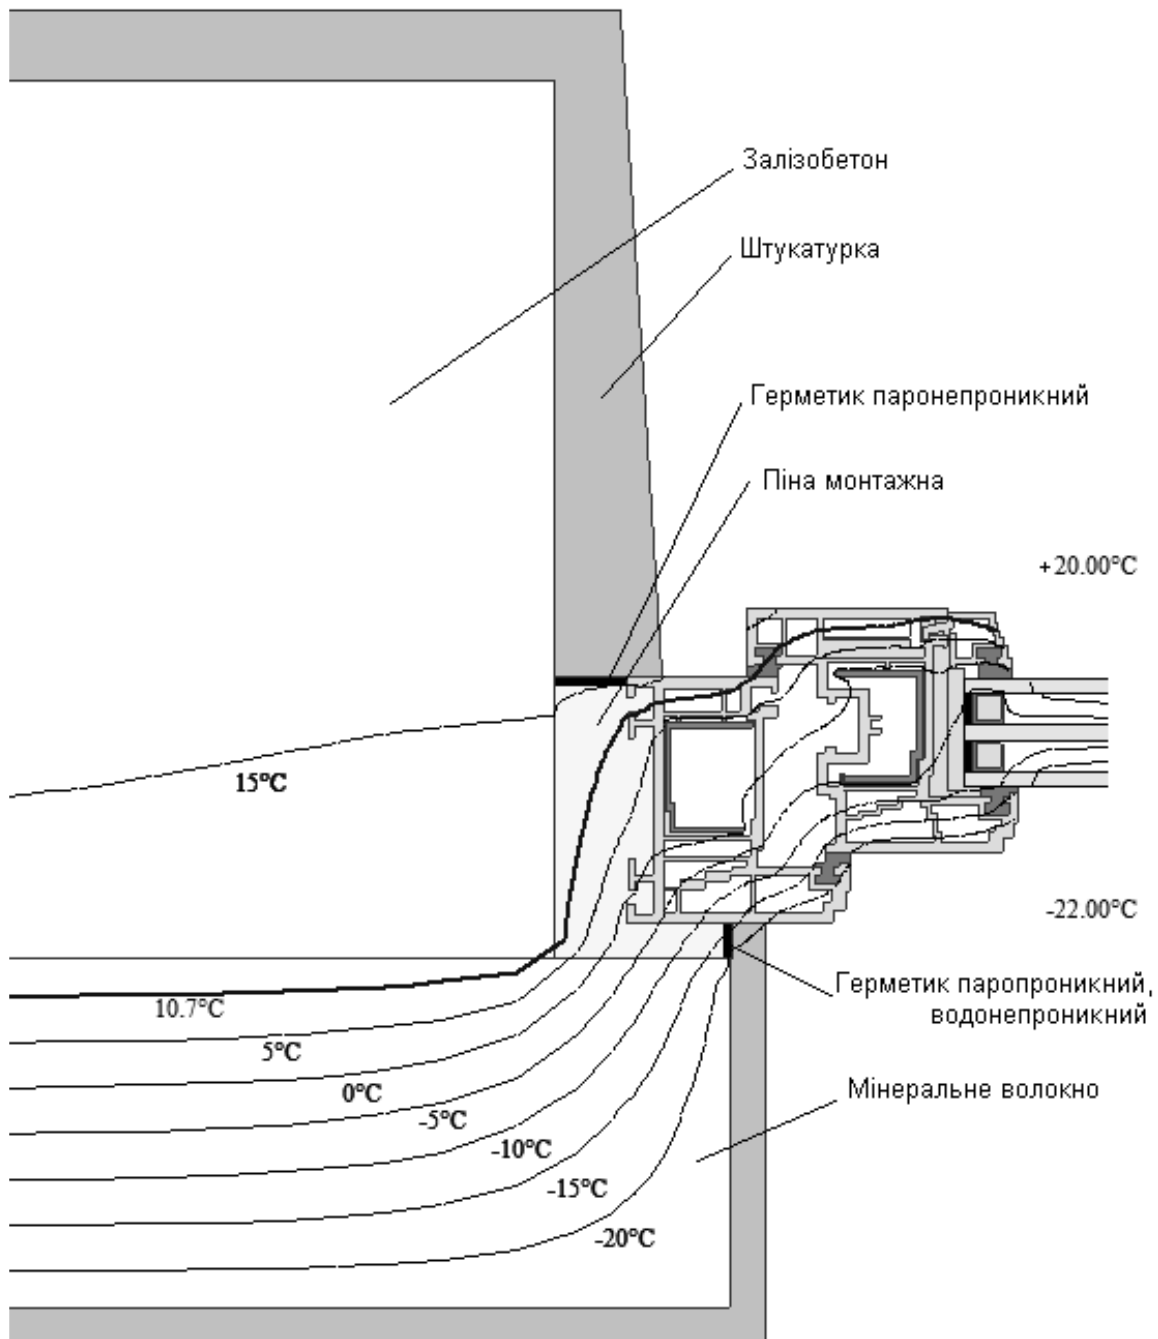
Узел бокового примыкания оконного блока с ПВХ профилей к стеновому проема стены из бетона толщиной 250 мм без четверти с внешним утеплителем из минеральной ваты толщиной 100 мм
